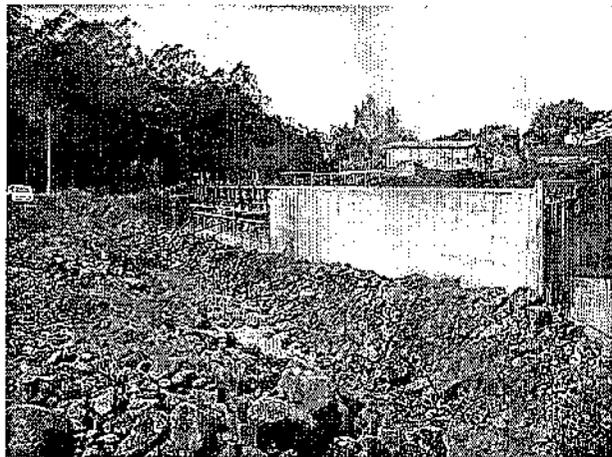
Ao fundo, execução da ensecadeira com o desvio do arroio, para a execução do BDCC
